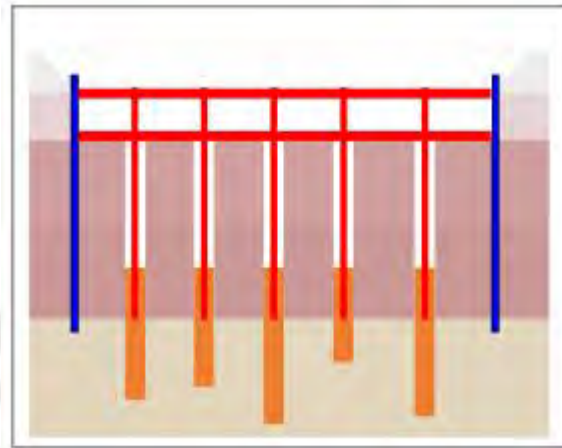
Excavación del primer sótano y construcción de elementos estructurales horizontales.
